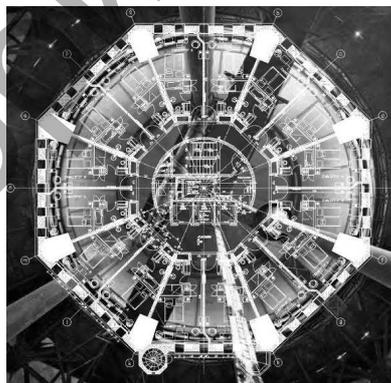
План этажа отеля Movenpick в Гамбурге
